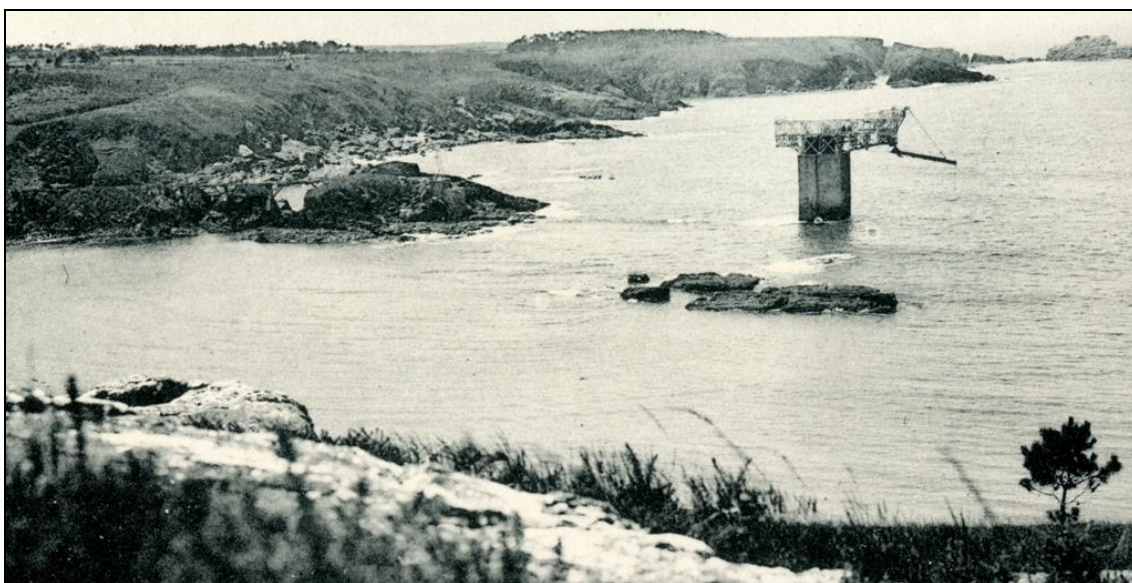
Pila del cargadero, hacia 1920 (Fot. J.M. Sanchis, 2014)
